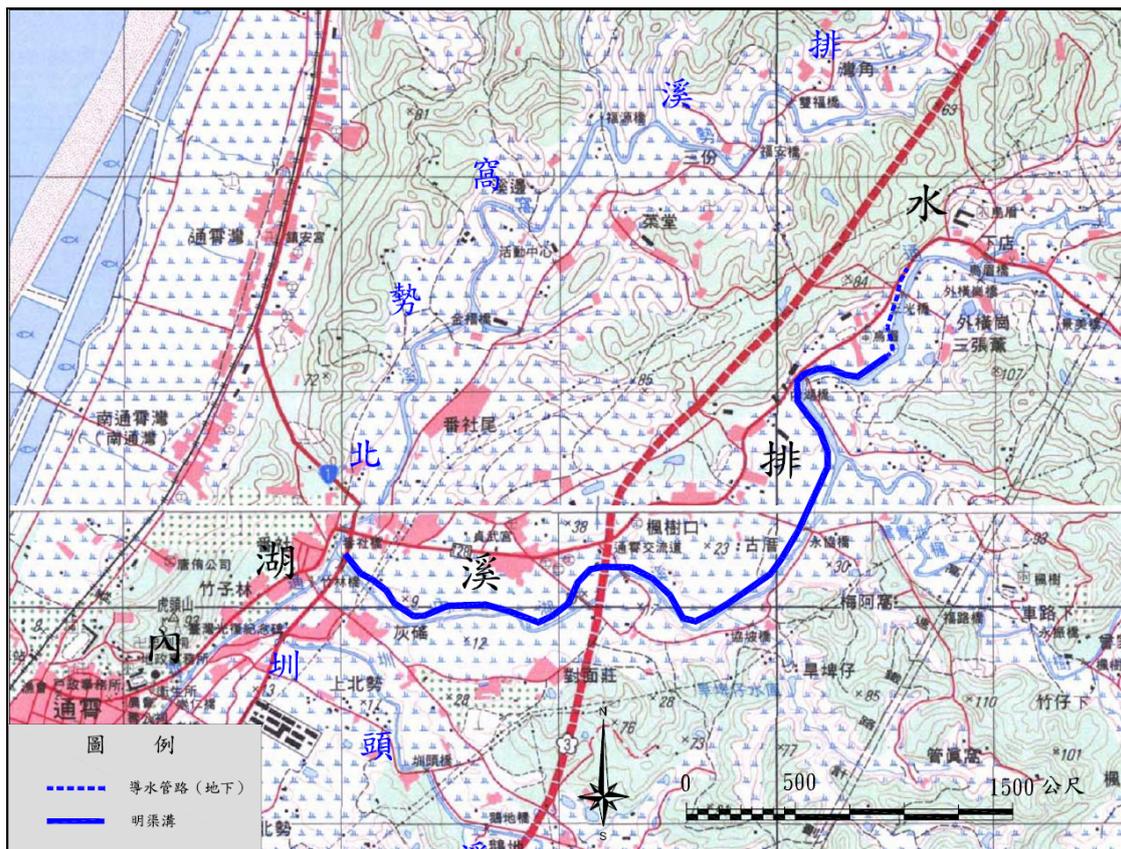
內湖溪排水導水管路線規劃平面布置圖
